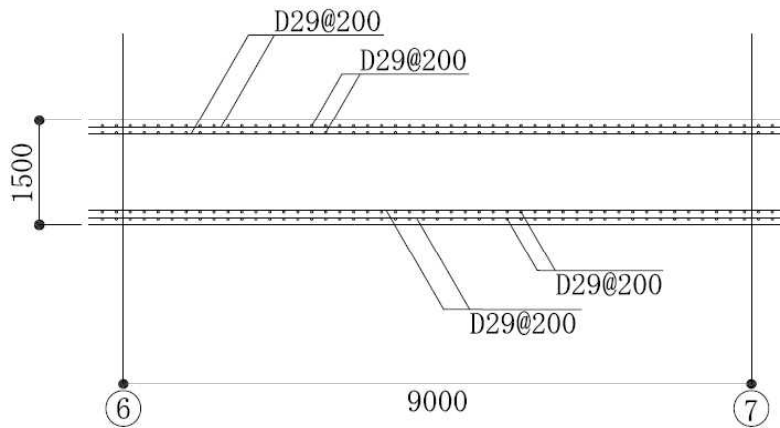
基礎スラブの配筋図 (F 通り、単位 : mm)
